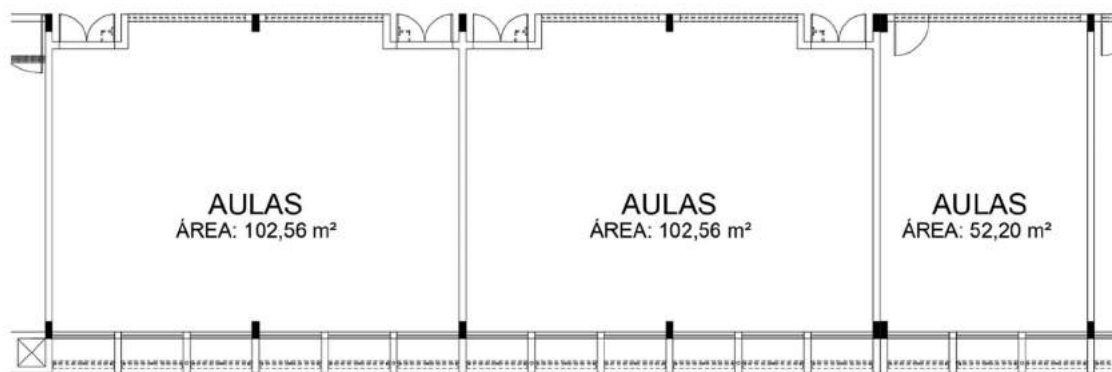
Locais em que foram adicionados pilares na concepção estrutural proposta.
